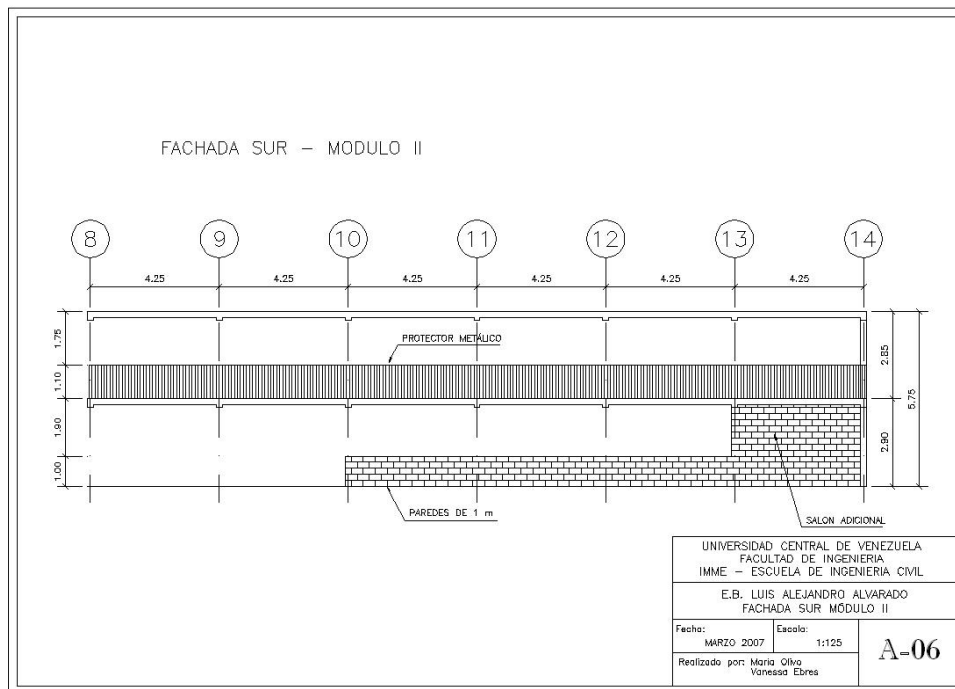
Plano de la Fachada Sur del Módulo II.
